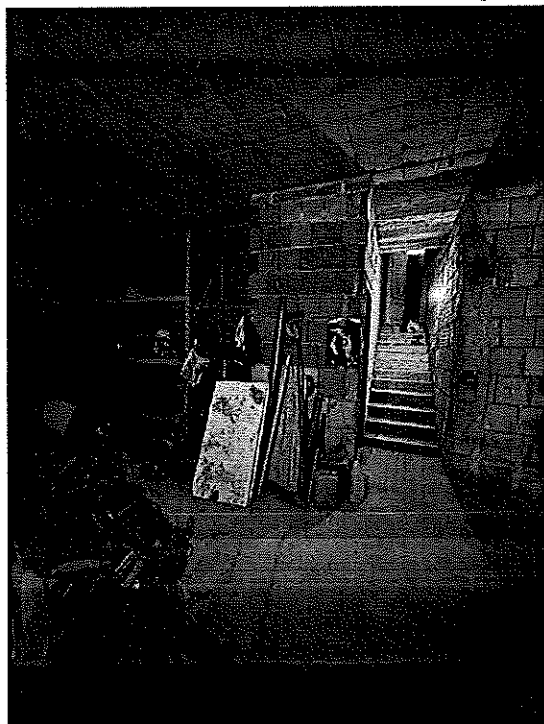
cantina e rimessa attrezzi al piano seminterrato
